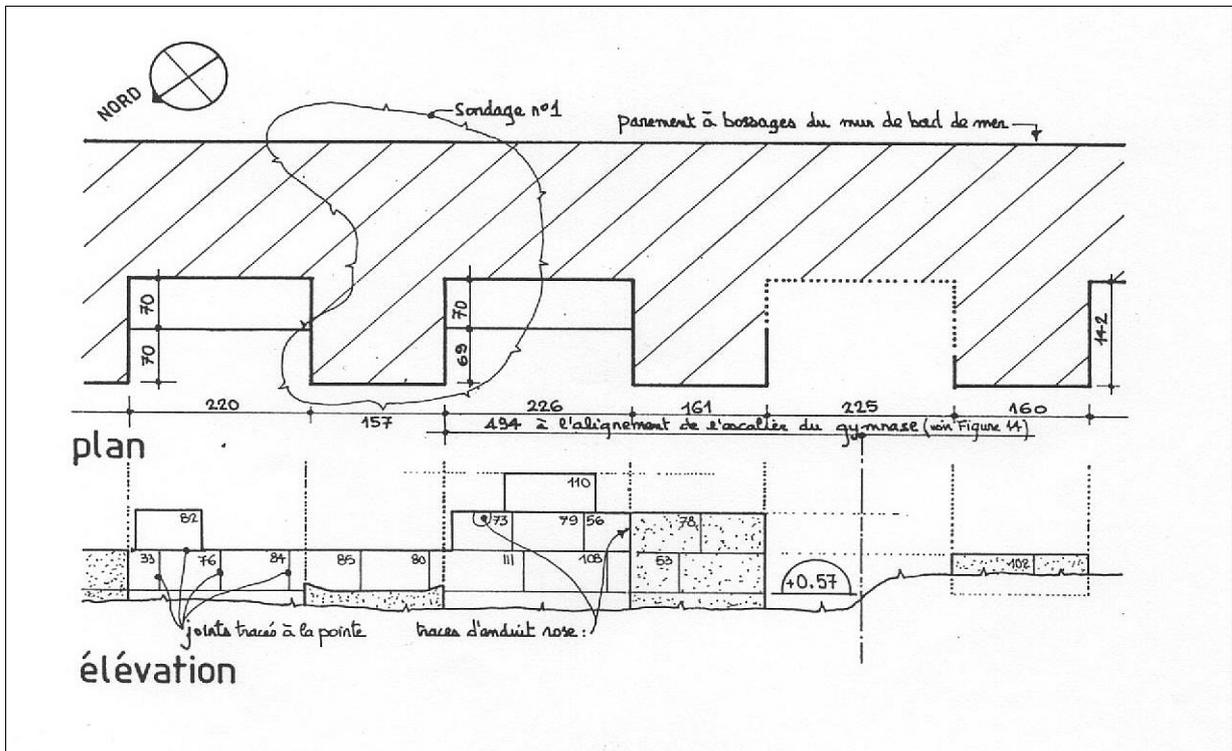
Relevés en secteur 1 : plan et élévation côté intérieur.
